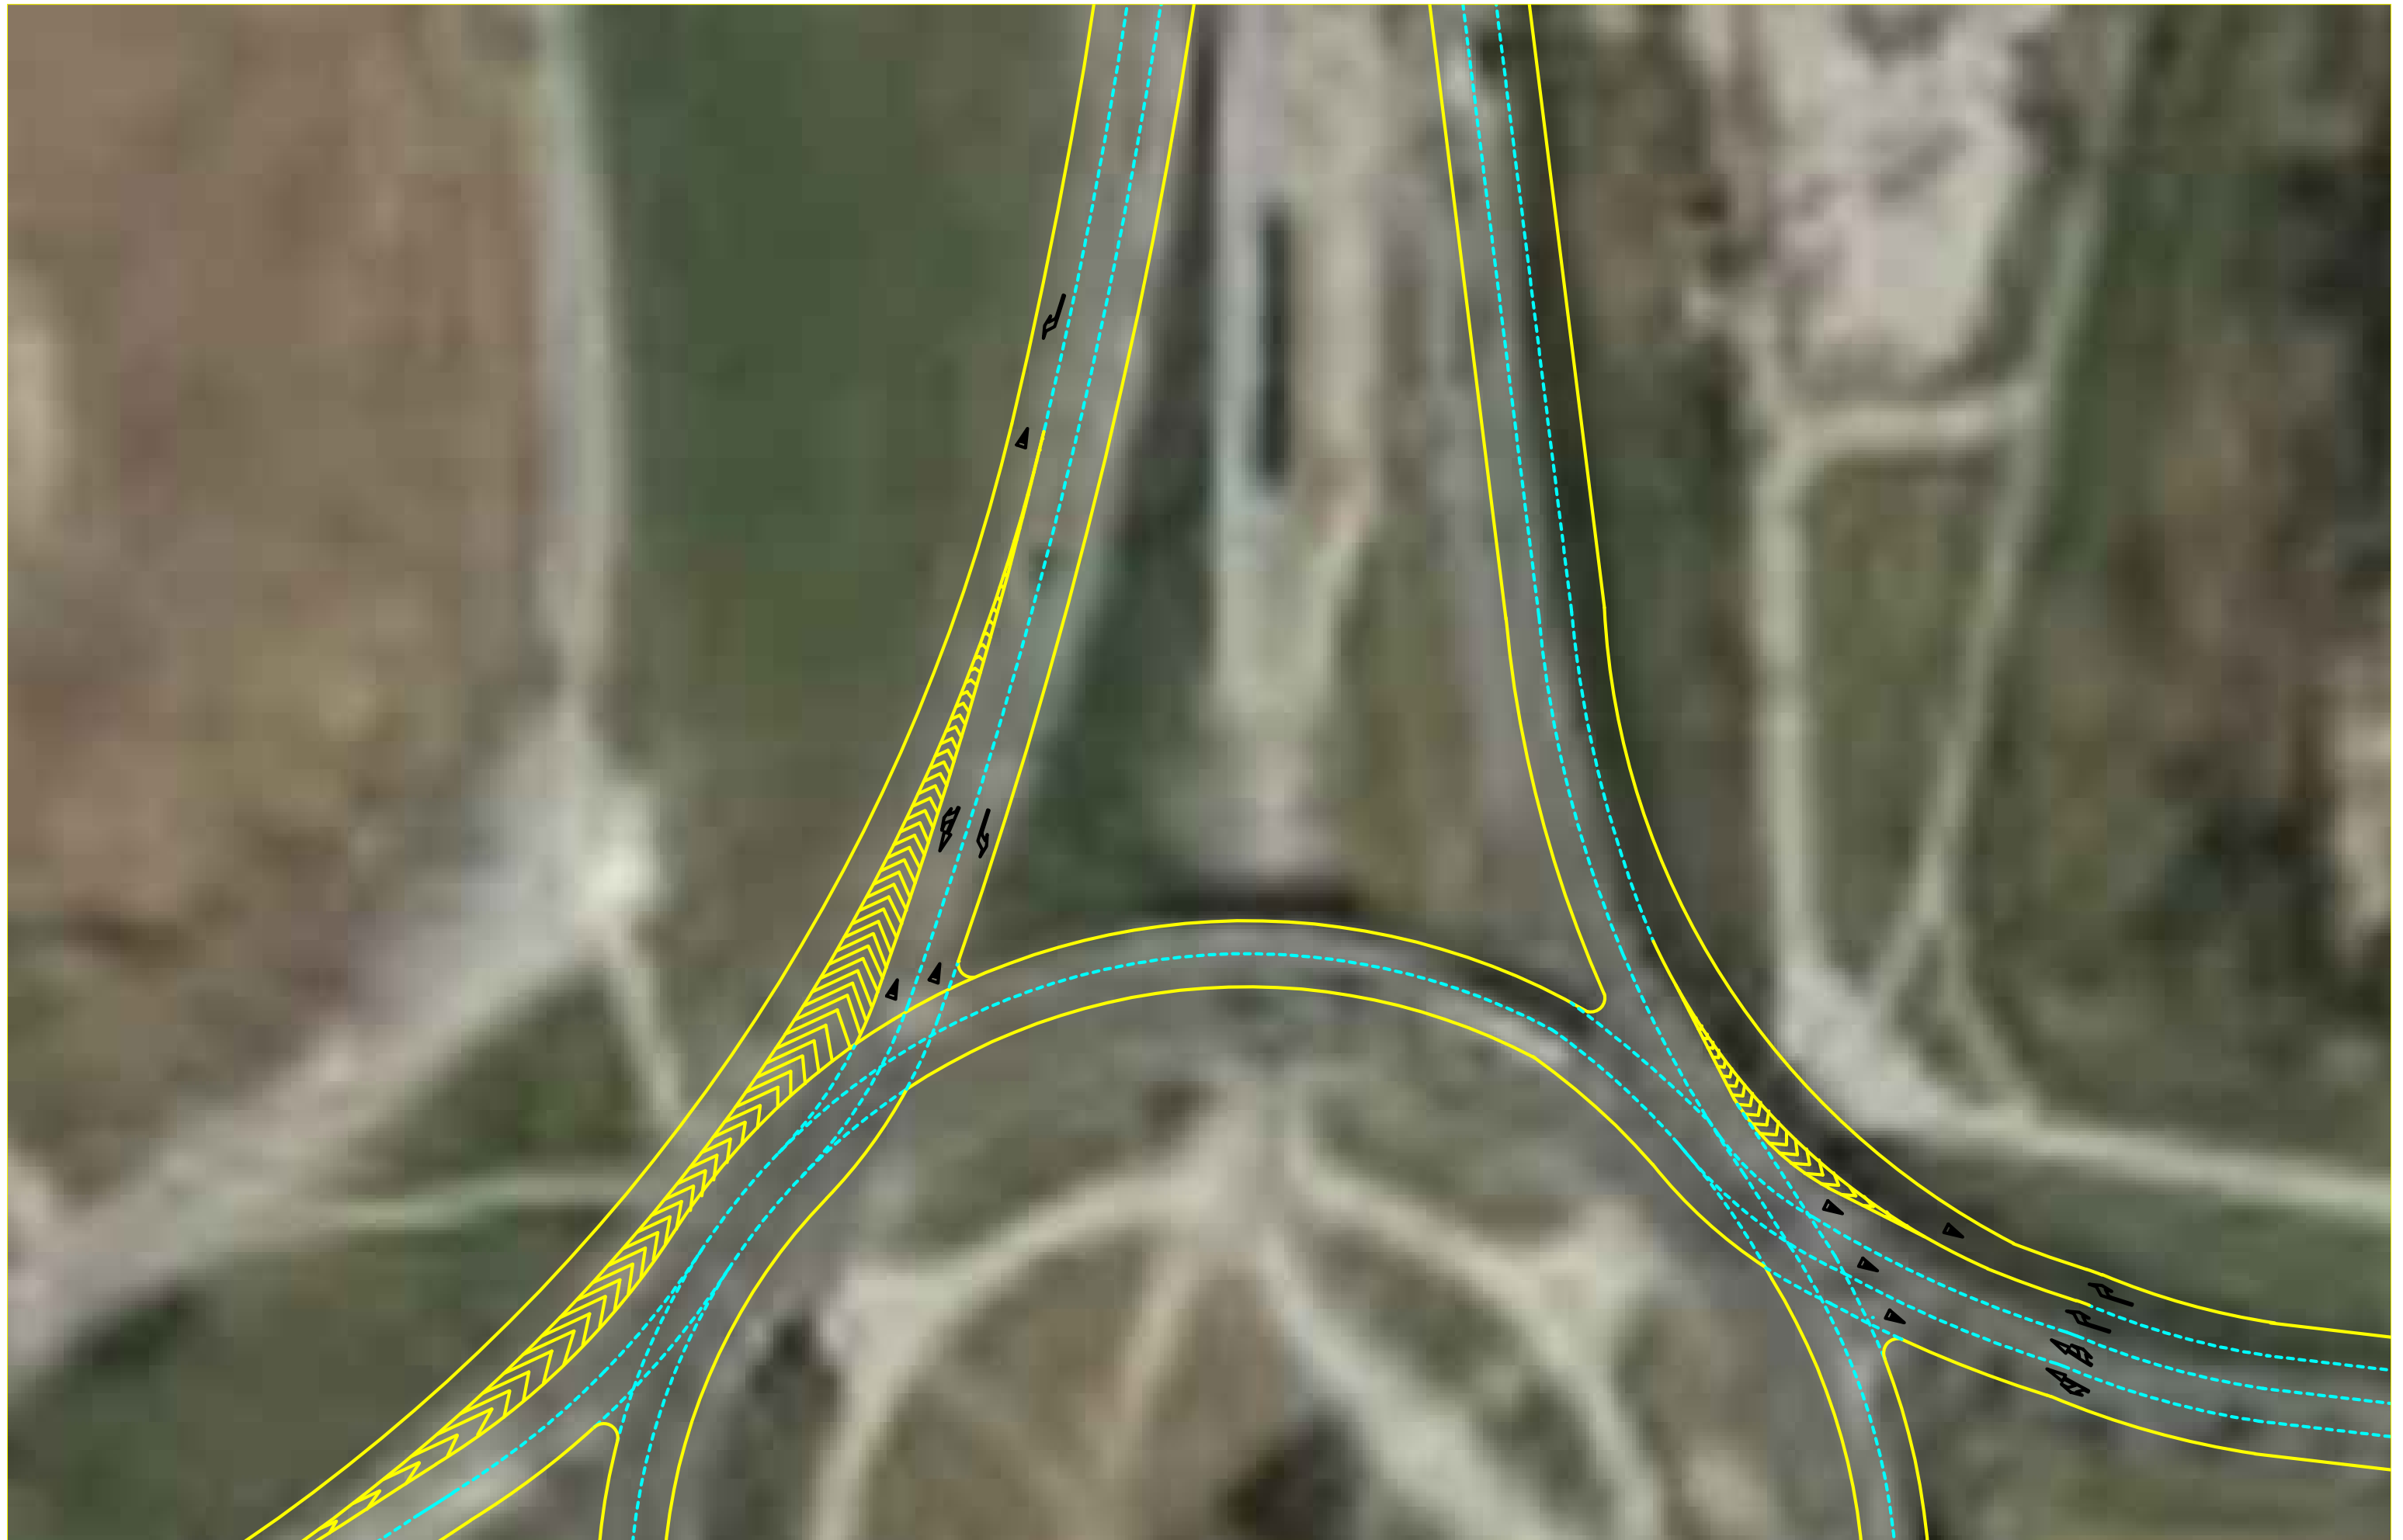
Rotor u Remetincu kao Turbo rotor (izradila autorica)
